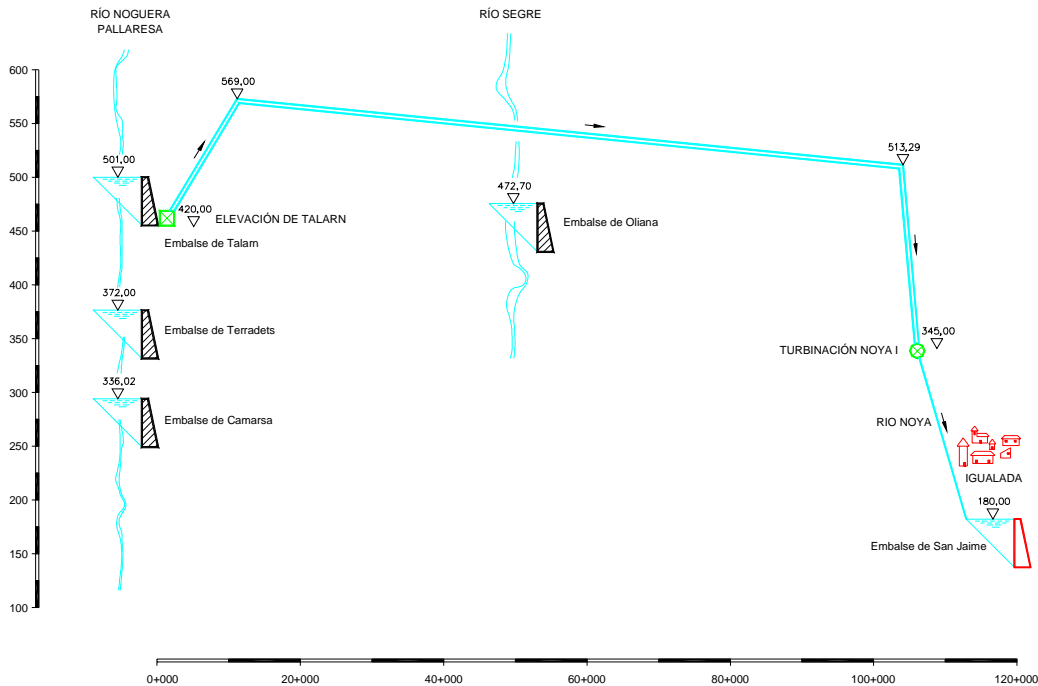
Conducción Segre – Barcelona. Esquema en alzado
